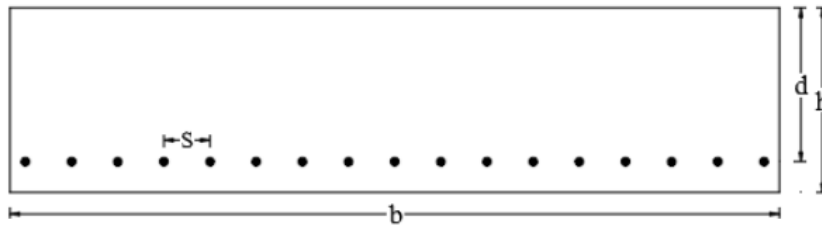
Configuración del refuerzo longitudinal inferior.
